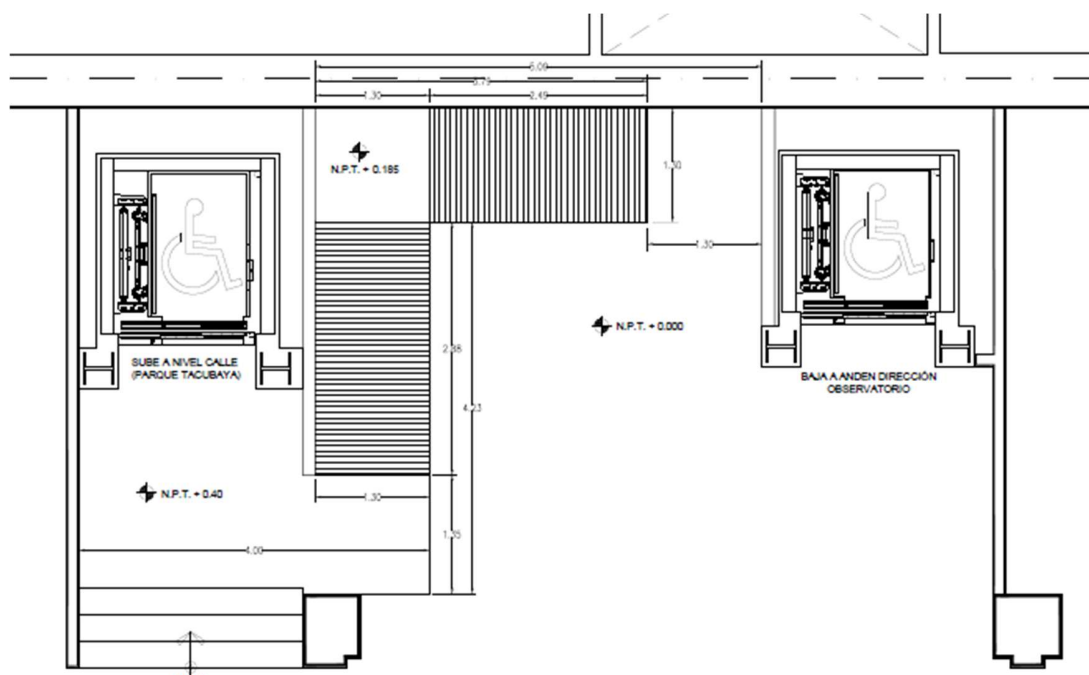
Planta de vestíbulo de elevadores. Elaborado por el autor.
